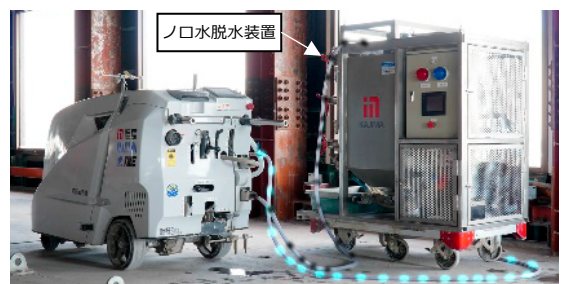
ノロ水脱水装置 (Concrete Sludge Dewatering and Separation Equipment)
